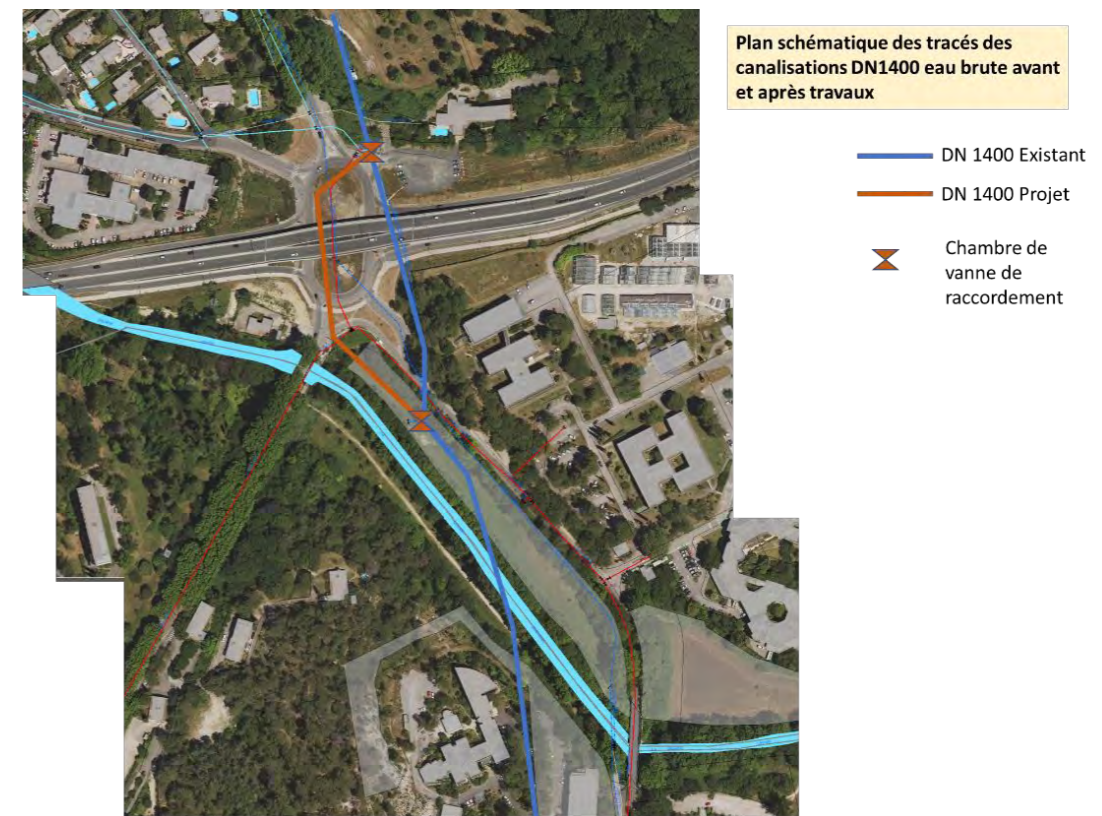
PLAN SCHEMATIQUE DES TRACES DES CANALISATIONS DN1400 EAU BRUTE AVANT ET APRES TRAVAUX
